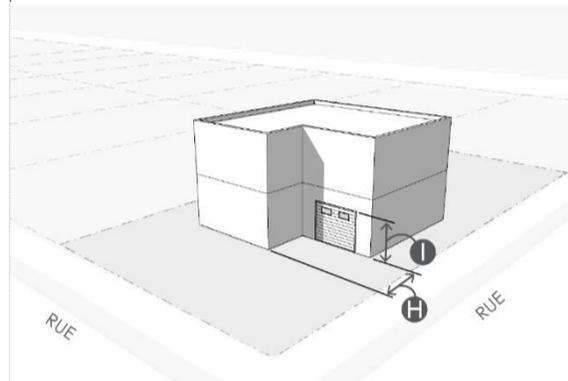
Retrait d'un garage par rapport à un plan de façade principal et hauteur d'une porte de garage
